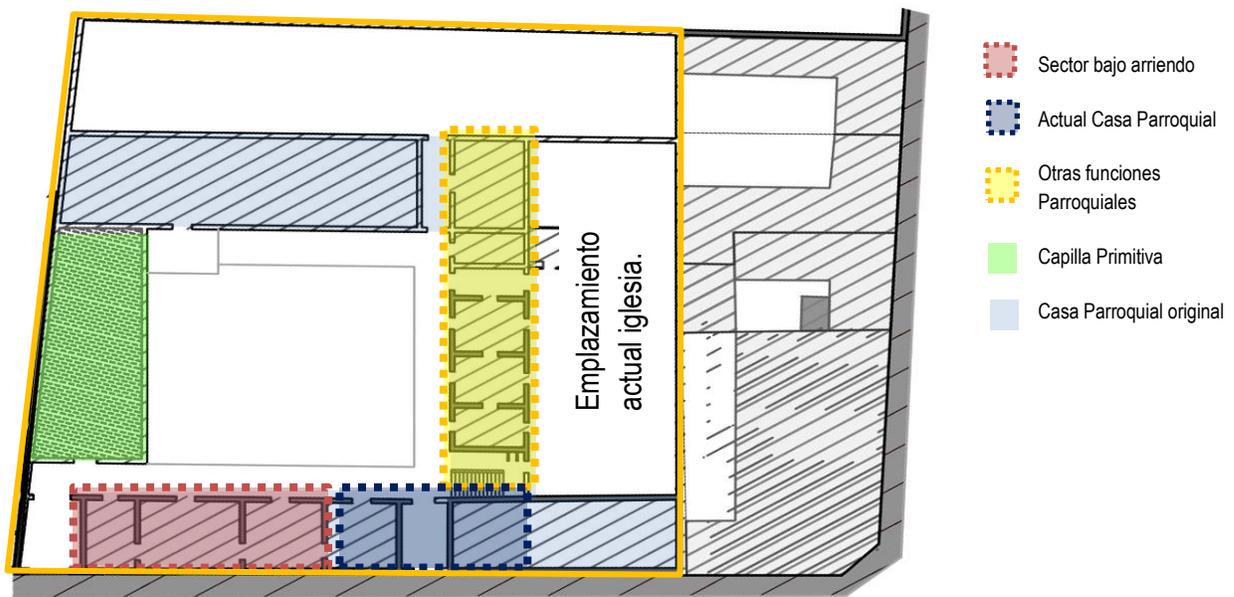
Identificación de estado de predio en 1910, intervenido por autores. Fuente plano base: Fondecyt "Reconstrucción planimetría Santiago 1910.")
